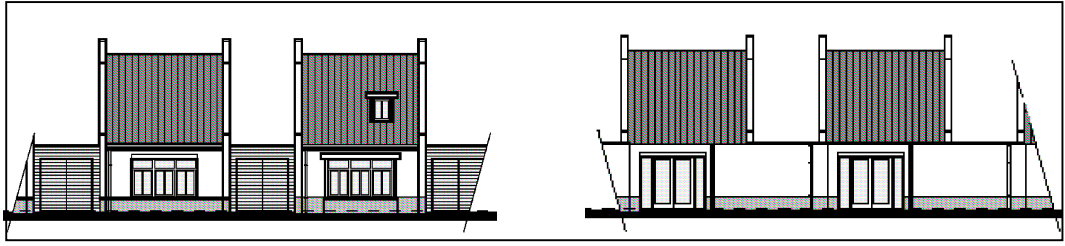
Voor- en achtergevel tussenwoning en hoekwoning met garage (type A en B)
